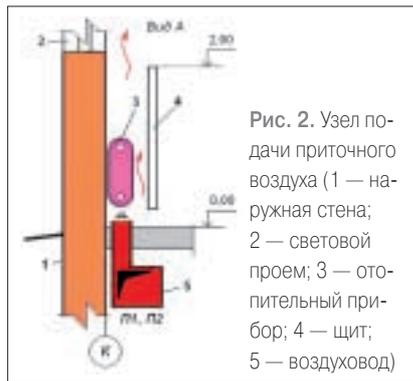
Узел подачи приточного воздуха (1 — наружная стена; 2 — световой проем; 3 — отопительный прибор; 4 — щит; 5 — воздуховод)
